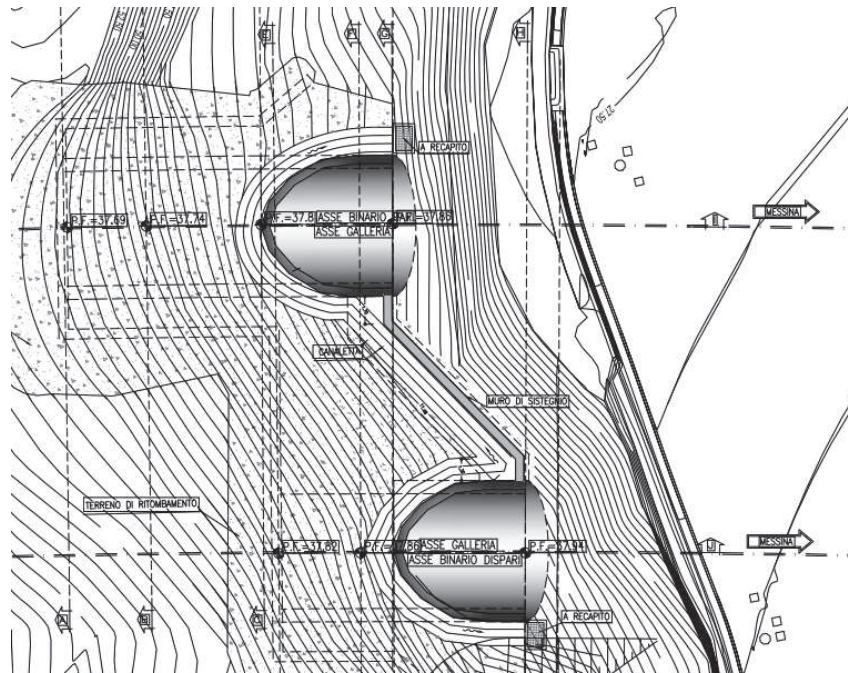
Stralcio planimetrico con individuazione dei muri d'ala definitivi
